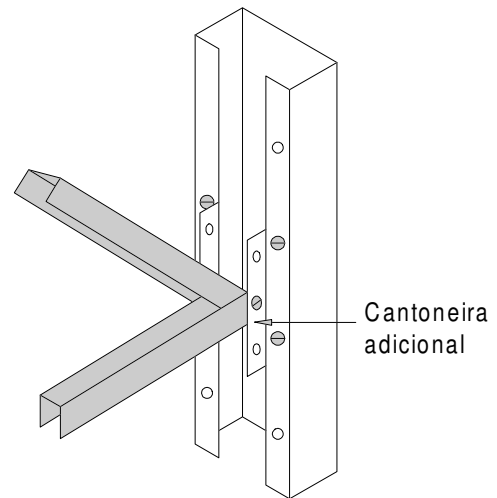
Perfil U enrijecido com cantoneiras adicionais para ligação dos elementos de contraventamento.
